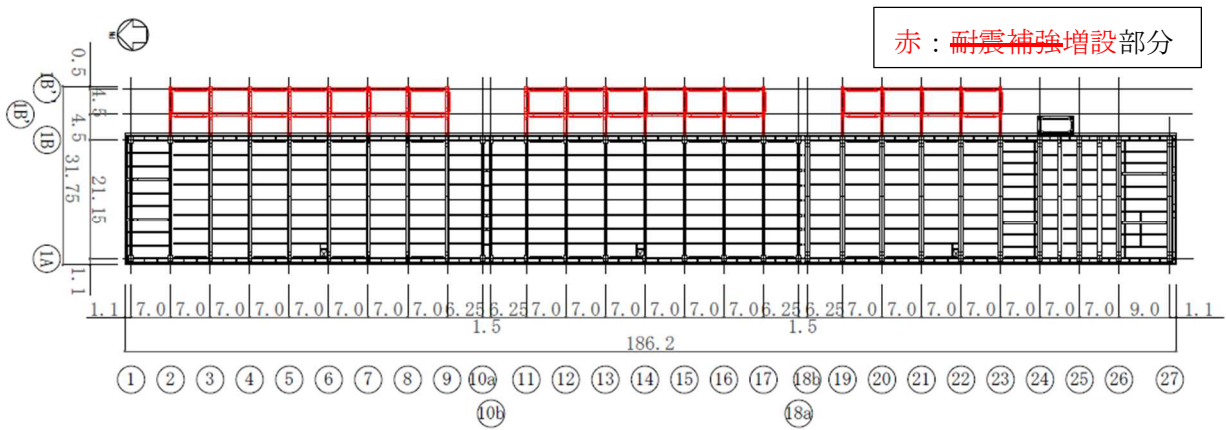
(23) 2階平面図 (G. L. +16.650) (単位 : m)
